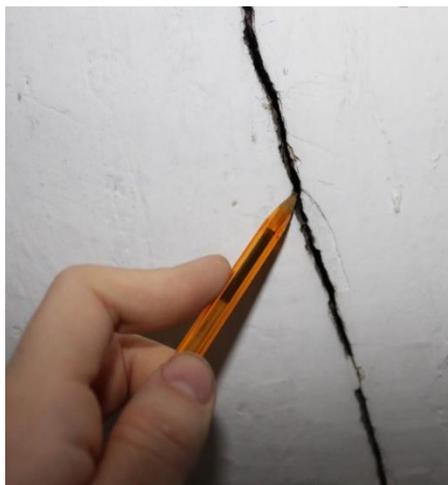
y 59. Grietas en acceso al coro.
